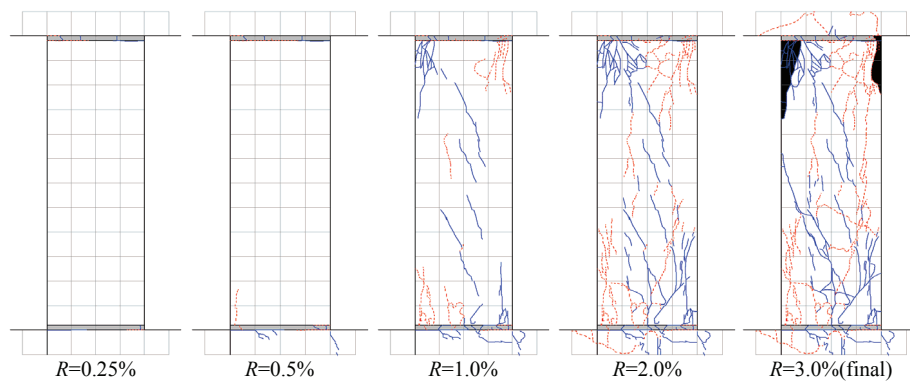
B1/2-0.1t ひび割れ状況
